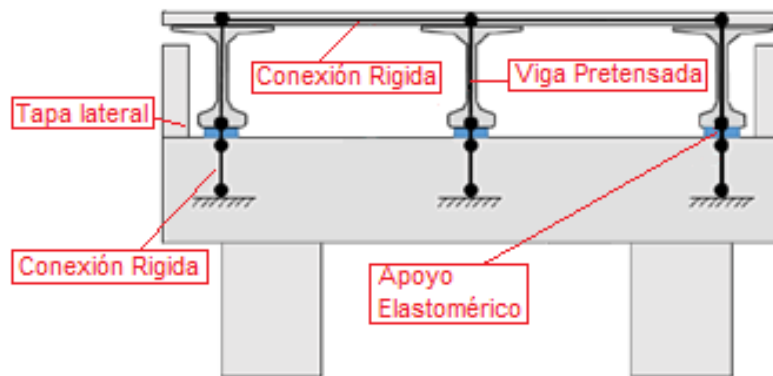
Elevación transversal en estribo, paso inferior Las Mercedes.
